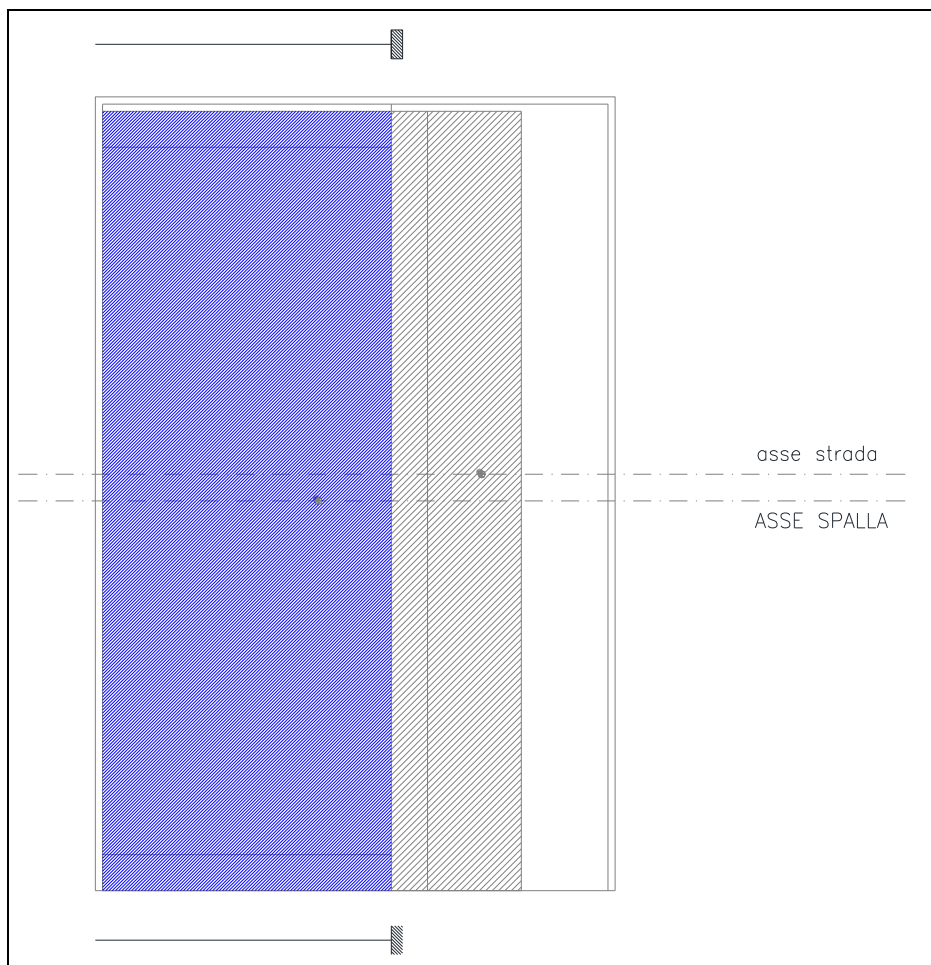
Spalla A - Schema statico equivalente per fondazione
